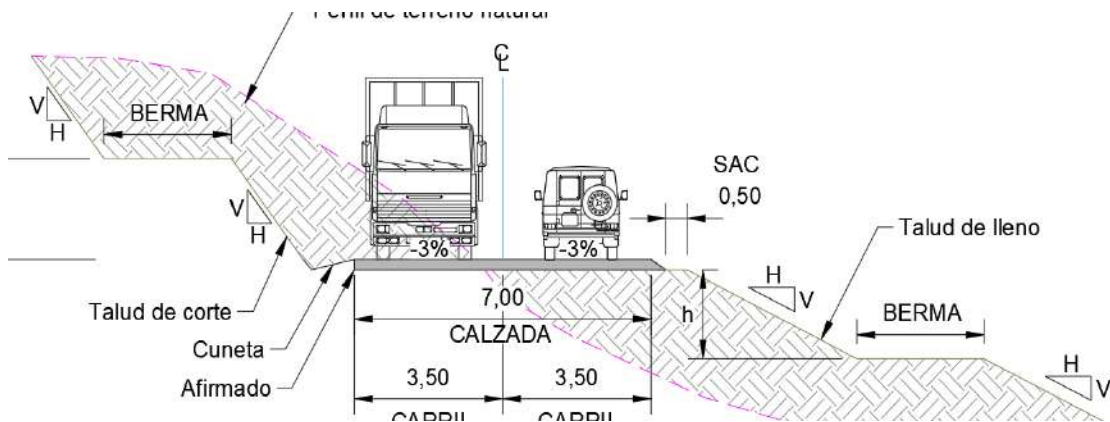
Sección típica vía para operación – Ancho 7,0 m
